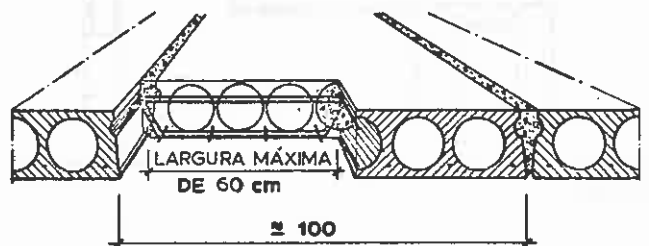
Pormenor de realização de abertura em pranchas vazadas (18)
